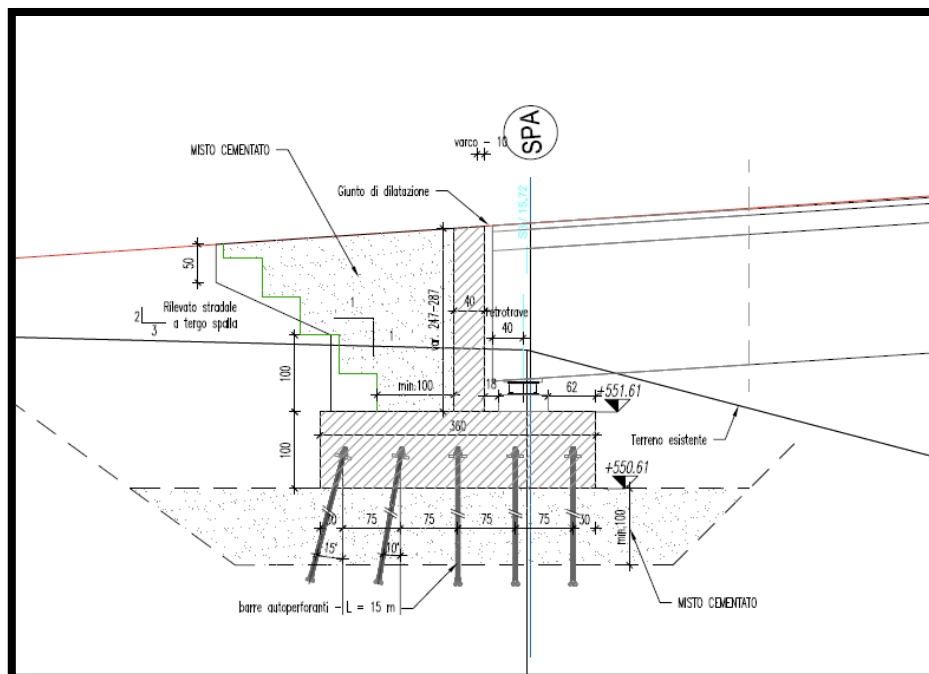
sezione della spalla A (spalla sx)
